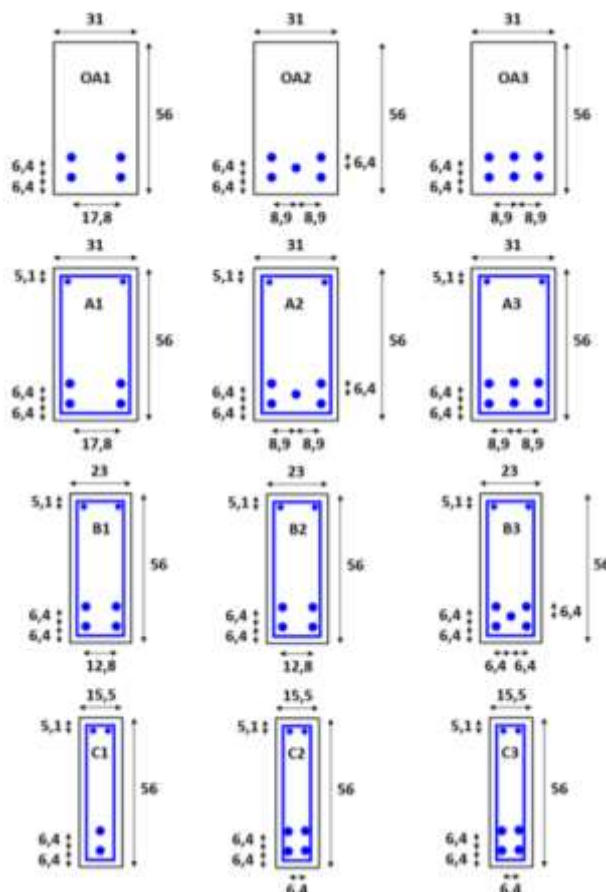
Detalhes das seções transversais das vigas de Bresler e Scordelis (1963) (cotas e medidas em centímetros).
